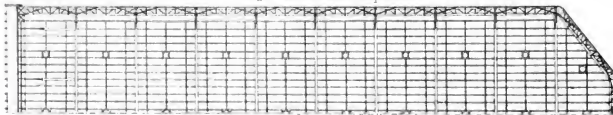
Ech¹/₁₀₀ Coupe transversale en avant d'une grande poutre
